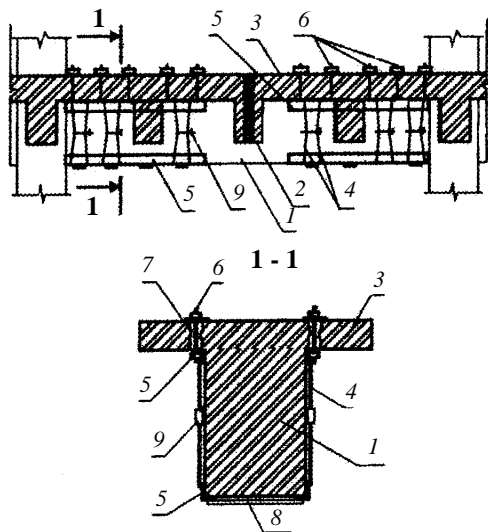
Установка стягиваемых поперечных стержней у опор:
